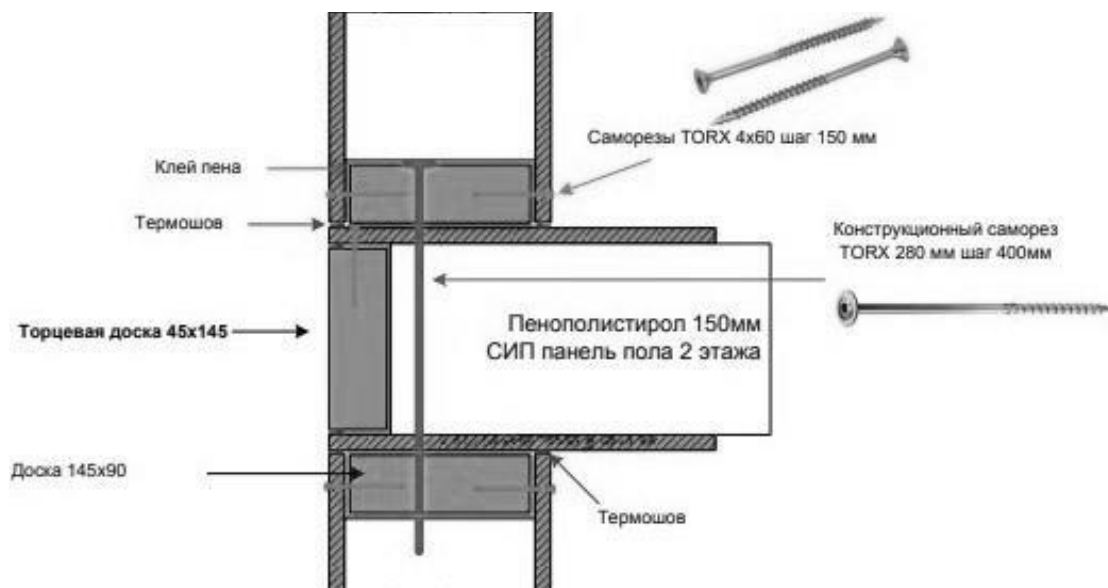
Узел соединения междуэтажного перекрытия со стенами
